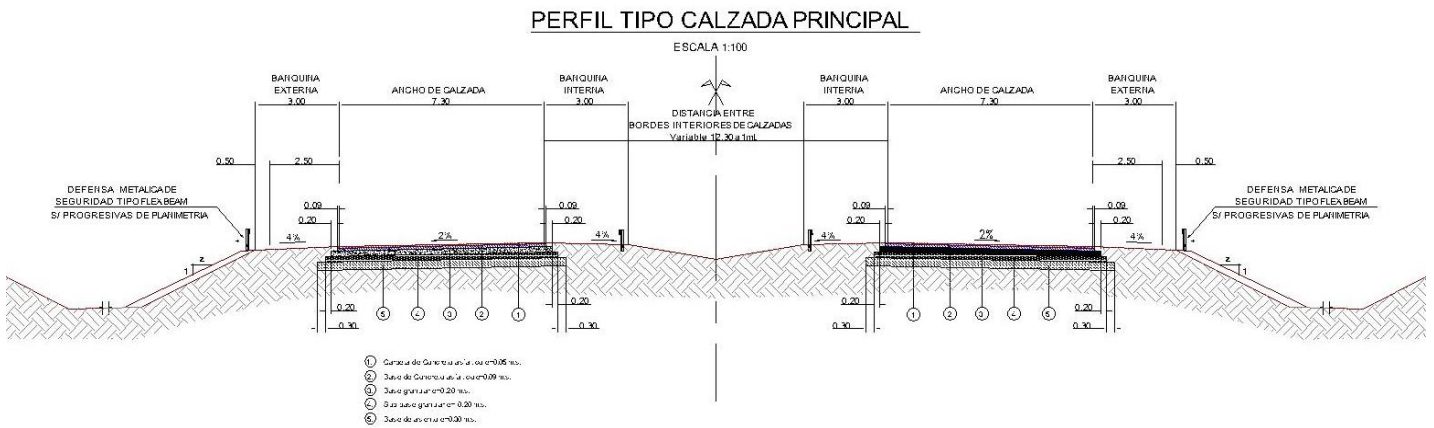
Perfil Transversal Empalmes entre Puentes con Av. Cárcano.
